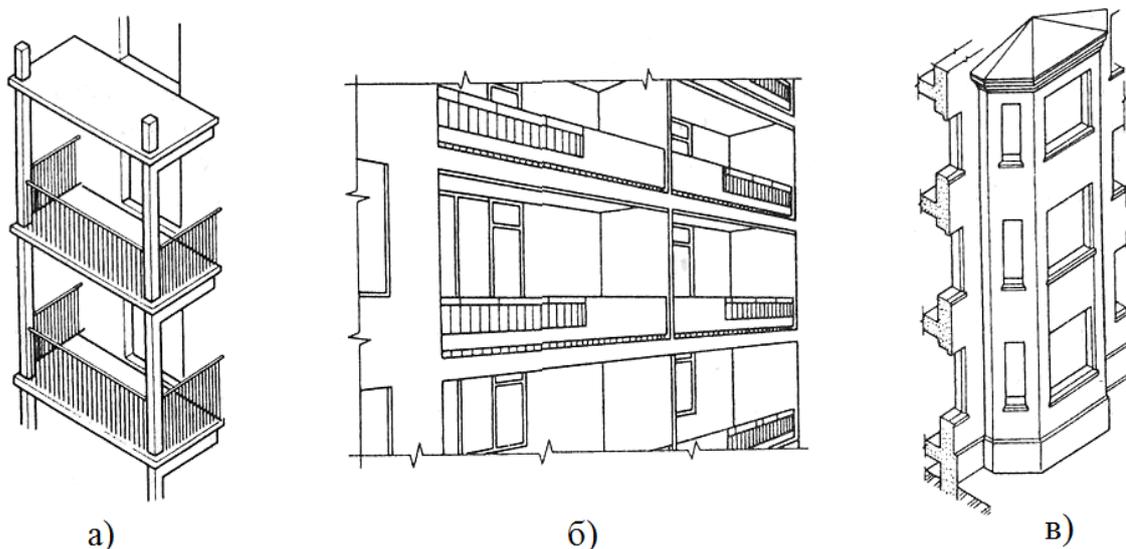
Конструкции специальных элементов мало – и многоэтажных жилых зданий:
